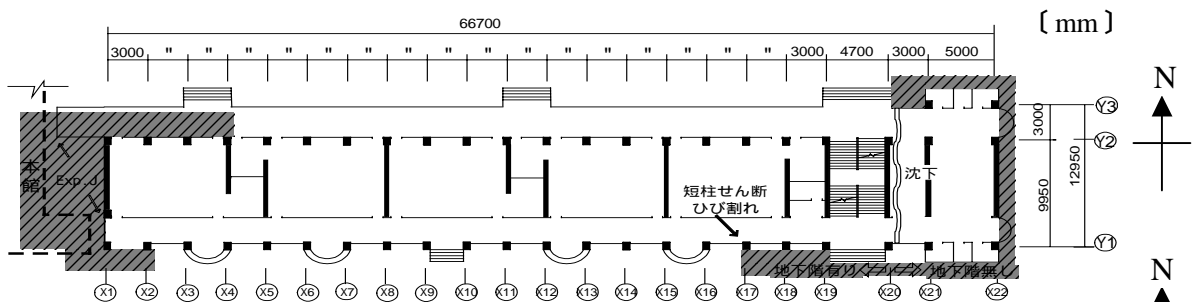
虎山国民小学校南館1階平面図と柱の損傷度  RC壁
